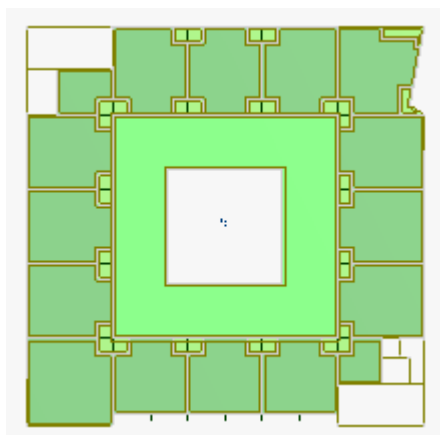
Planta de uma laje de piso apenas com painéis.
